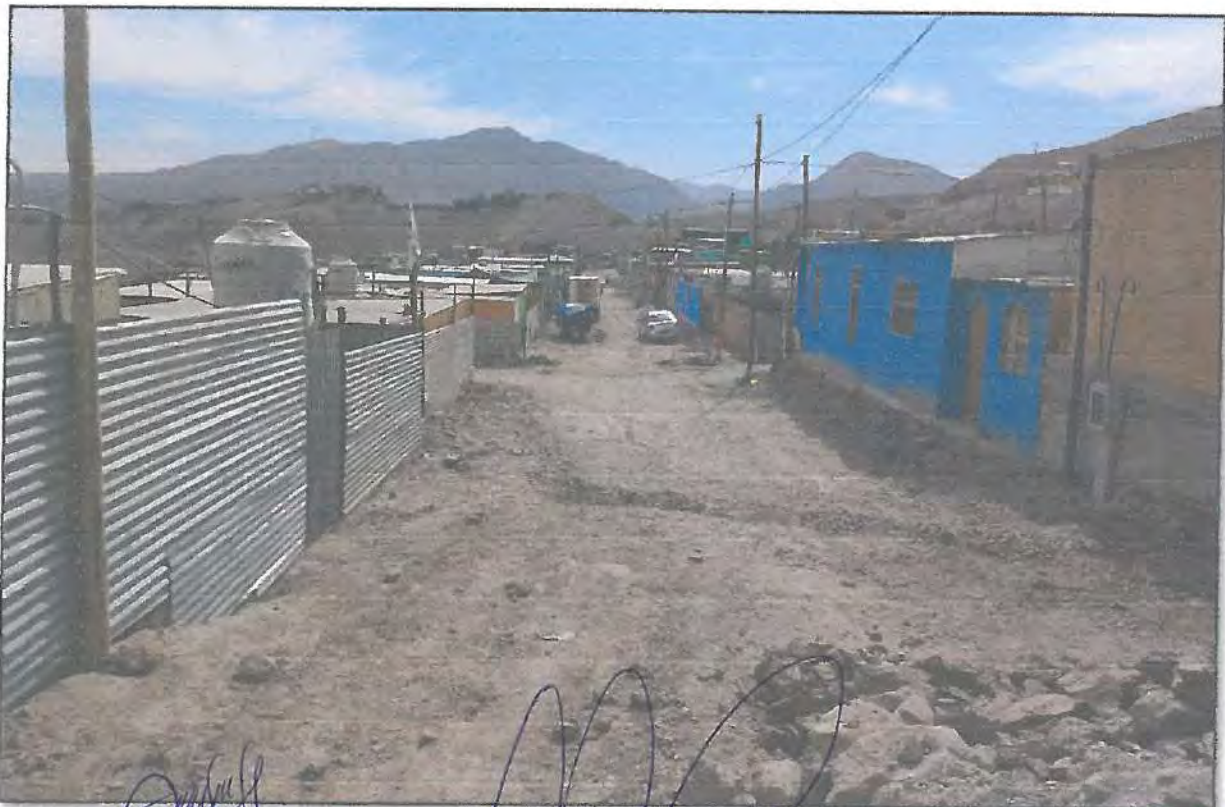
Vista de Calle N° 04 entre la manzana B y G
